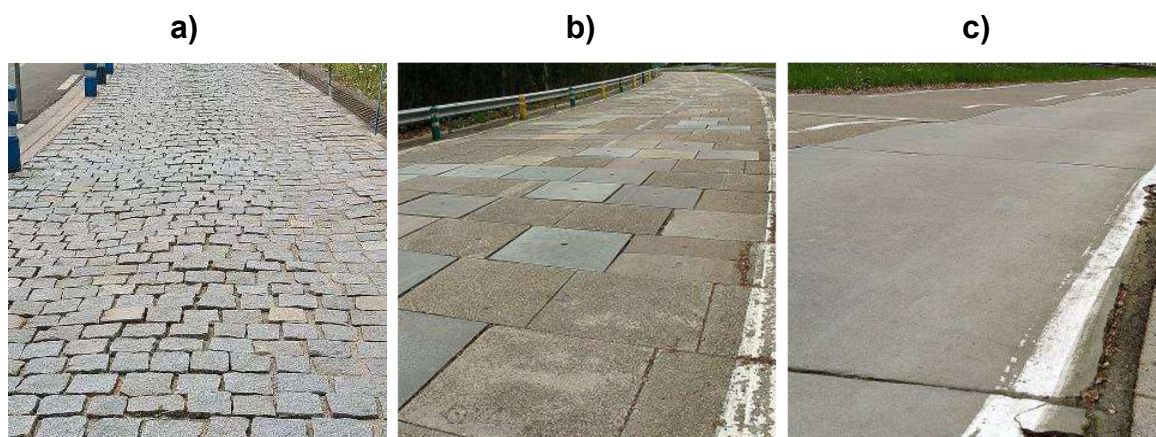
Photos des sections a) pavés, b) dalles espagnoles et c) ondulations
